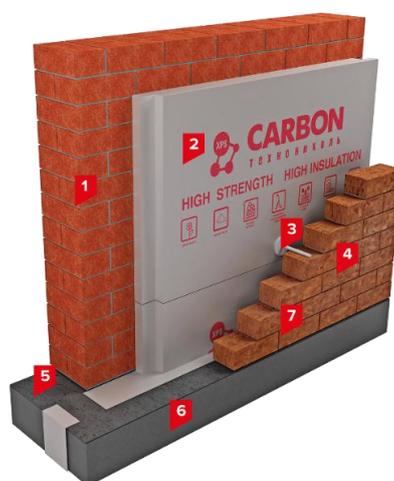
Конструктивное решение наружной стены с утеплителем из экструдированного пенополистирола:
